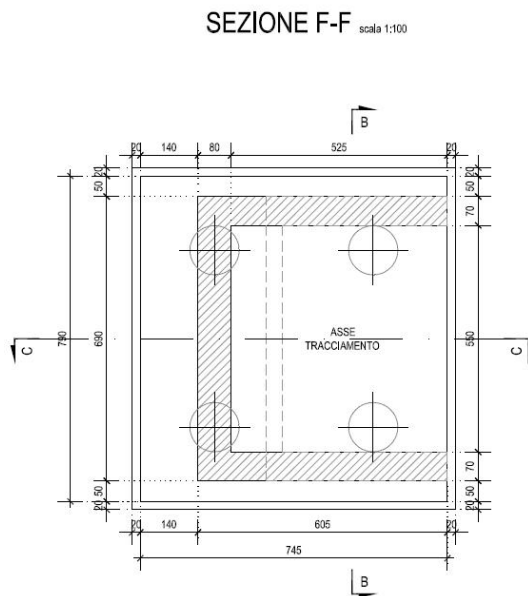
Pianta carpenteria - Spalla tipo
